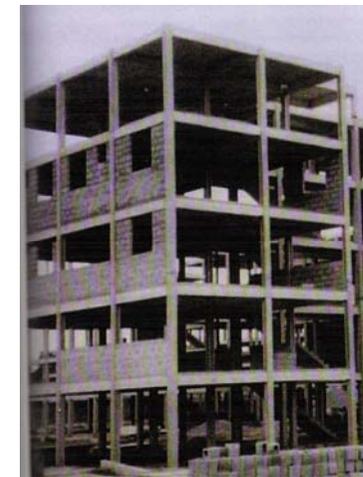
Foto de Mutirão Verticalizado, CDHU
